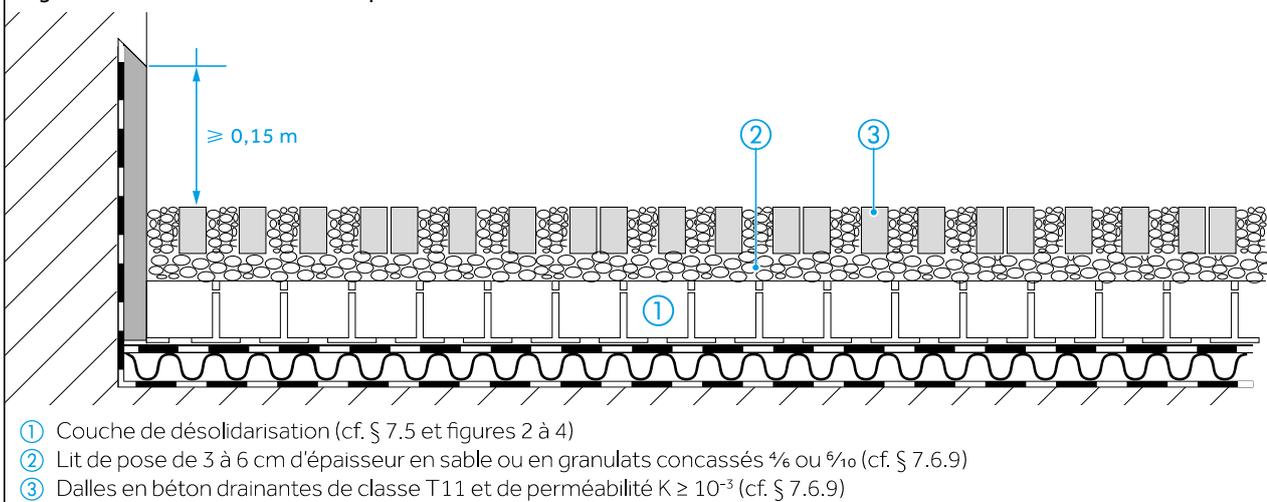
Toiture accessible aux véhicules légers avec dallage en béton sans rétention temporaire
